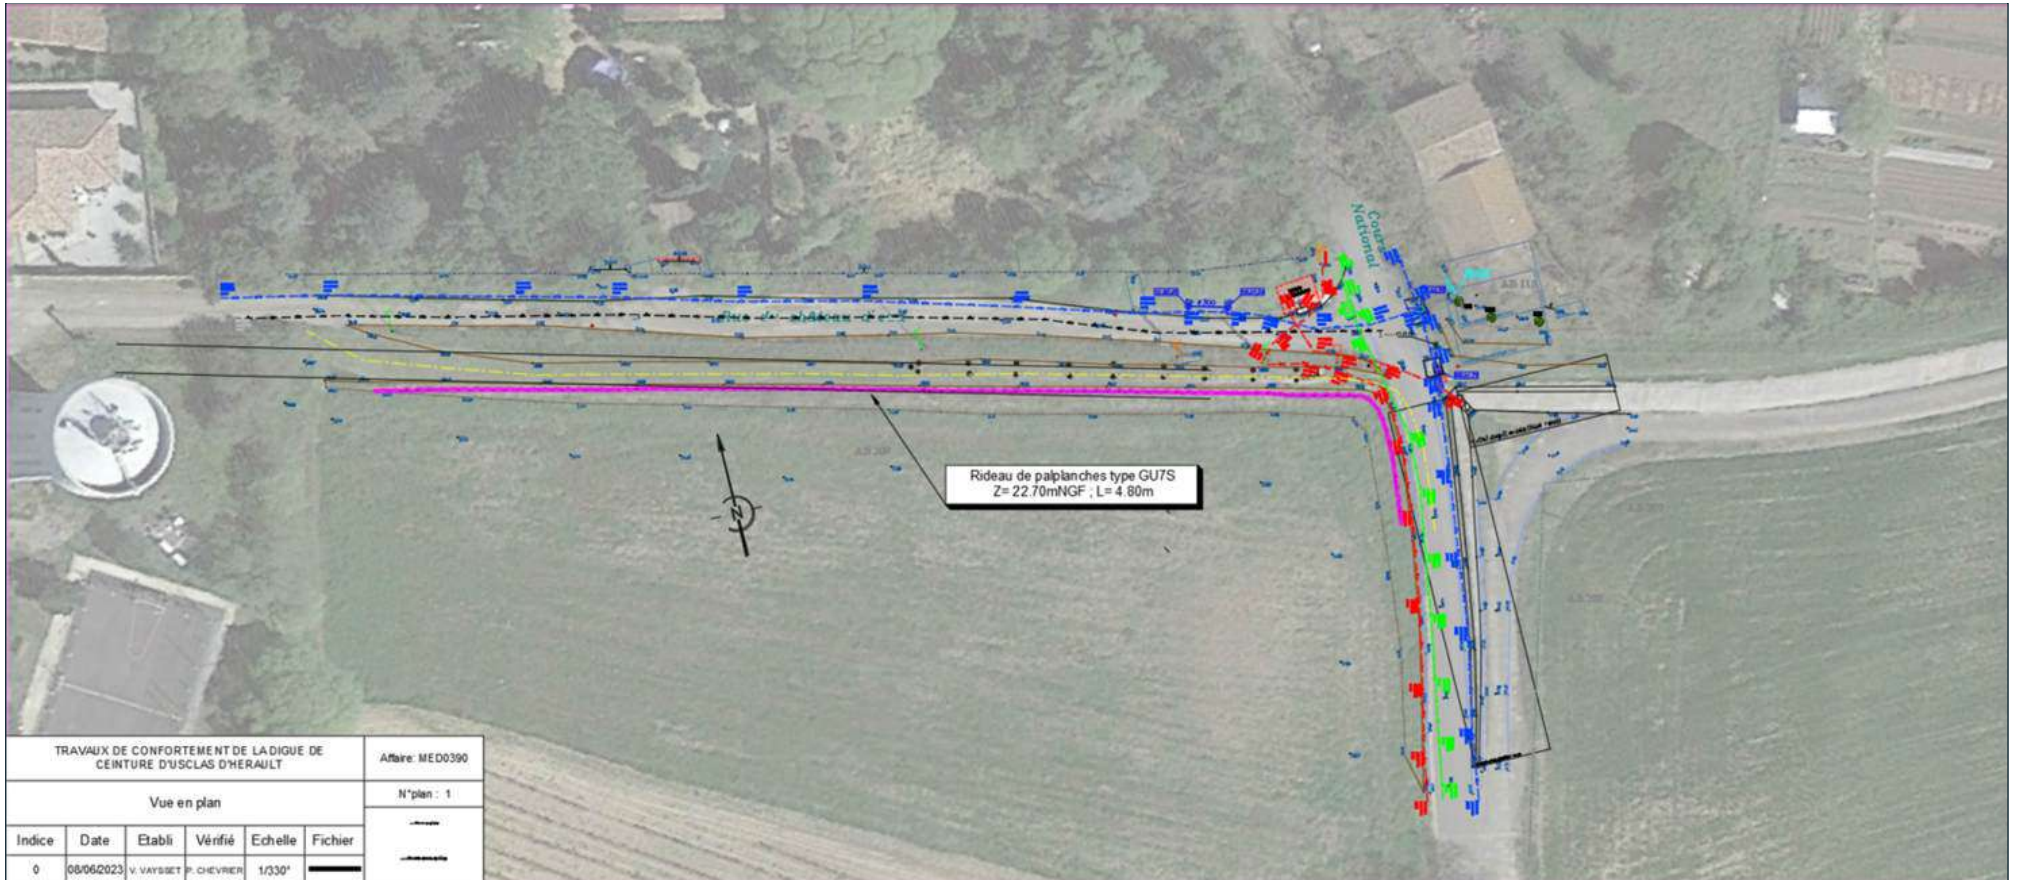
MISE EN PLACE DU RIDEAU DE PALPLANCHES –(2023)
